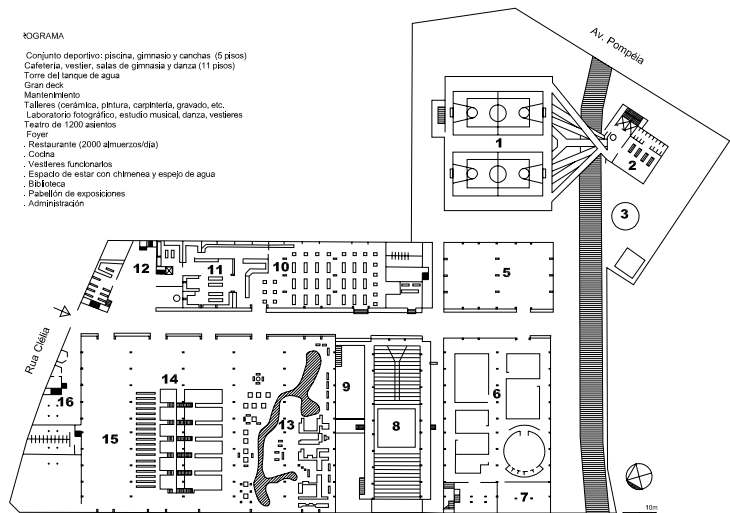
SESC Pompeia, São Paulo. Planta general del conjunto. Dibujo del autor a partir de planta en Bardi, 1993, p. 226.
